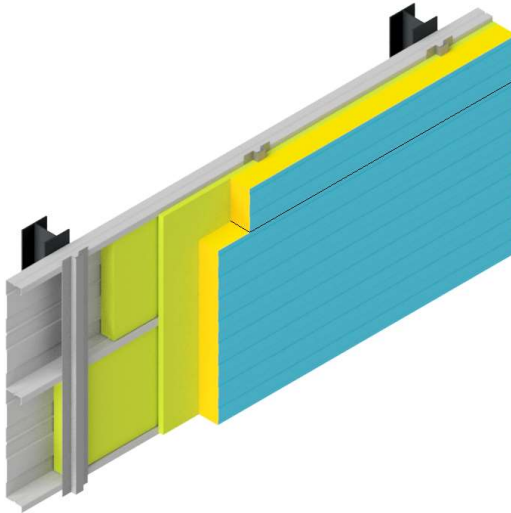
Hybridfassade mit horizontal verlegten Sandwichelementen und vertikalen Lisenenprofilen
